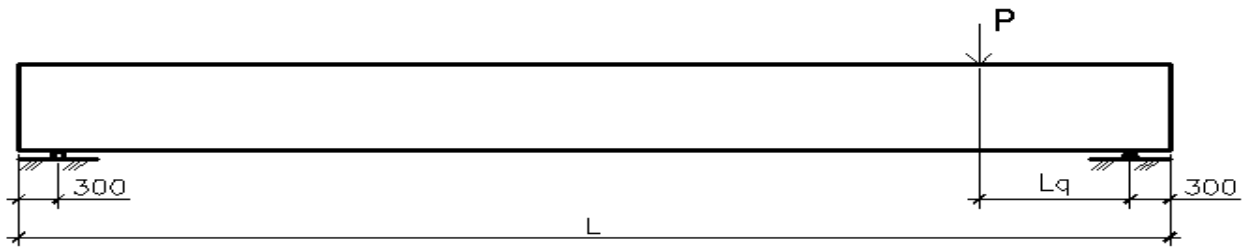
Схема випробування балок Б 1800.110.40 і Б 2100.110.40 на дію поперечної сили, де  $L$  – довжина балки,  $L_q$  – відстань прикладання навантаження
